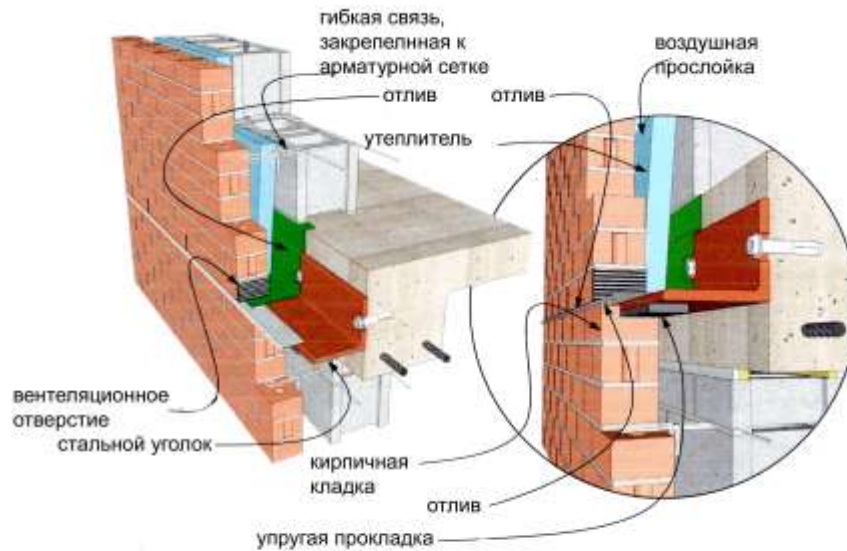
Типичная конструкция трехслойной стены с поэтажной разрезкой
